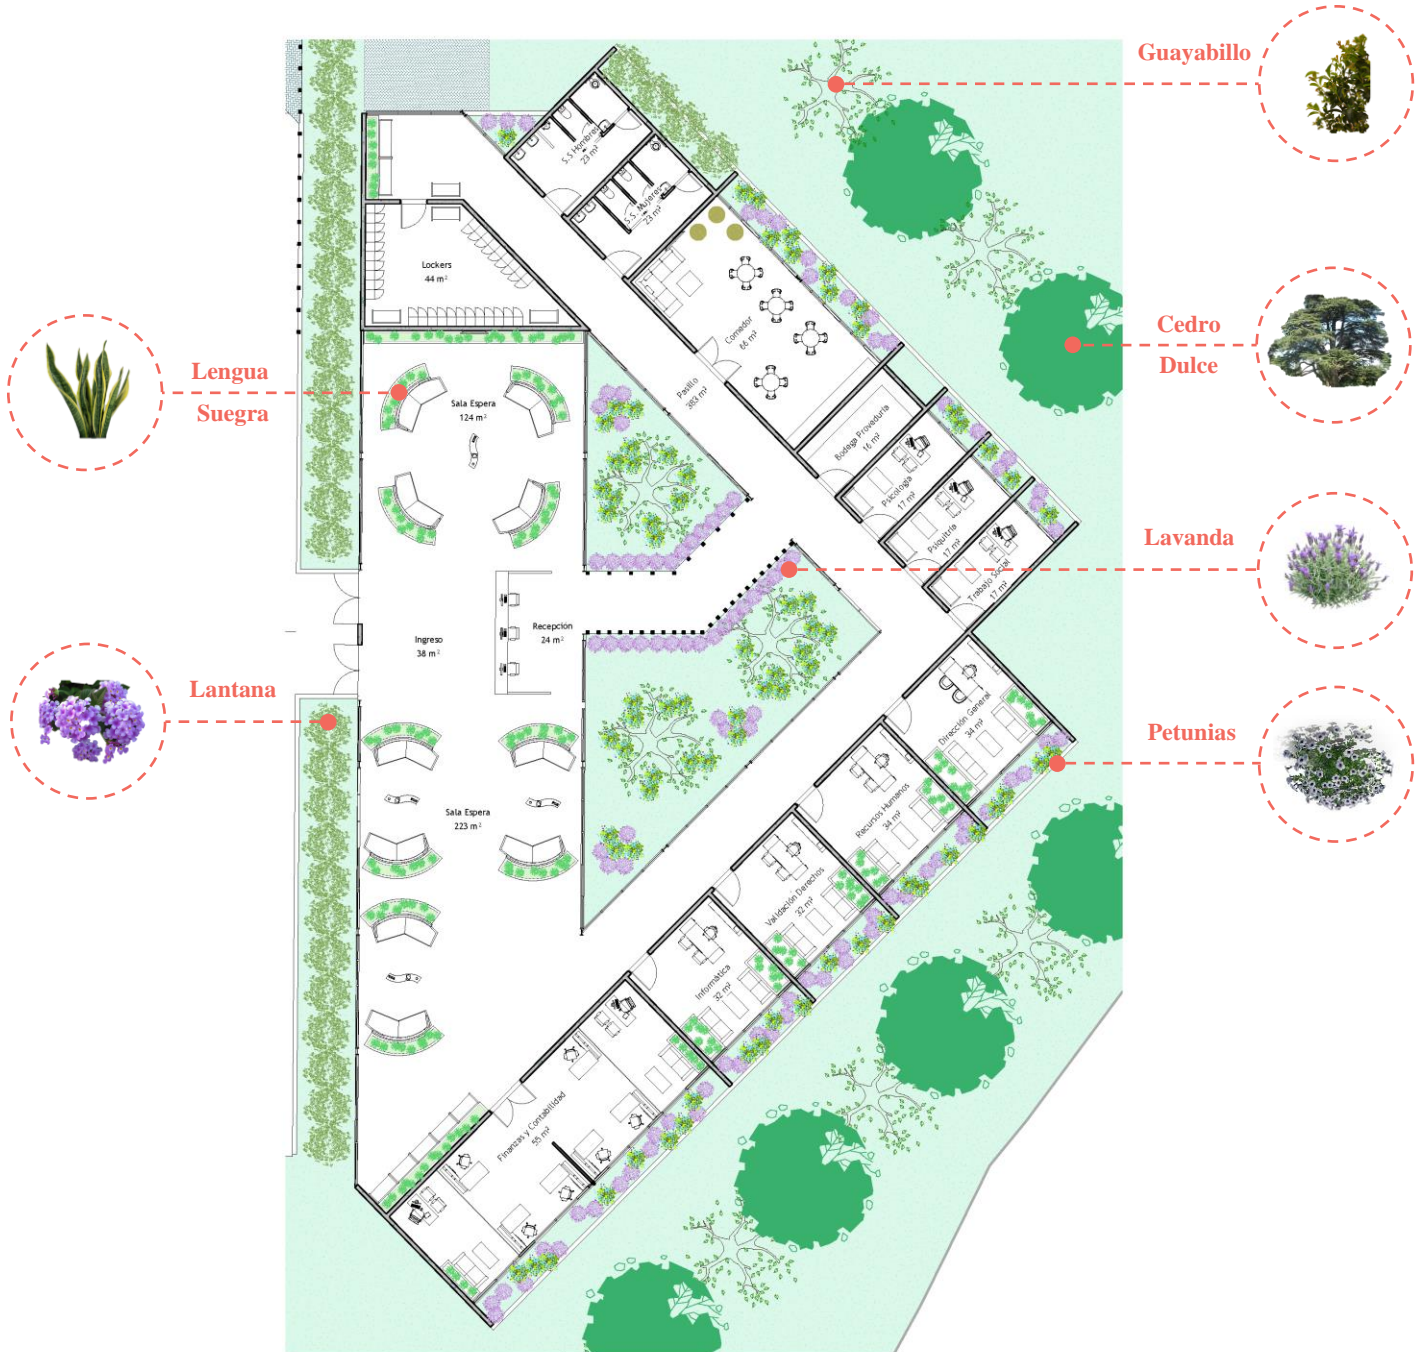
Planta arquitectónica de administración - Elaboración propia, 2024
